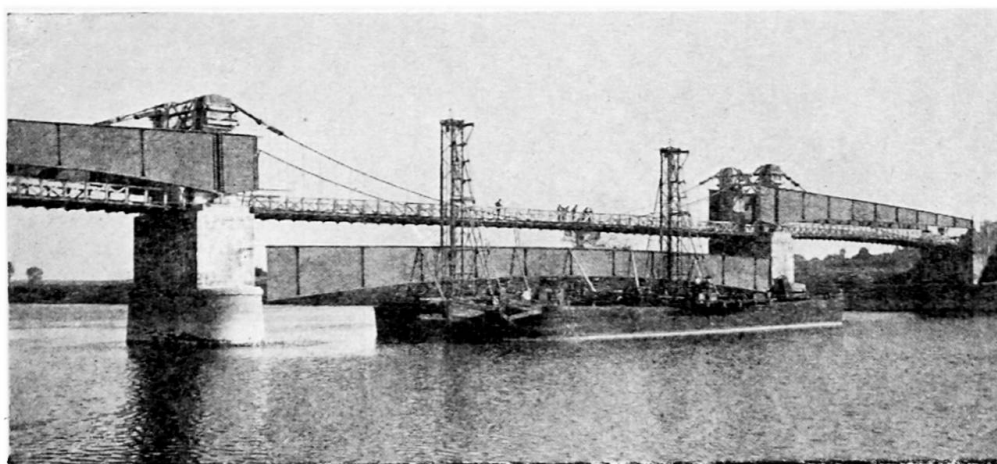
Pont route de Bragny—montage des poutres sur chalands (1936)
